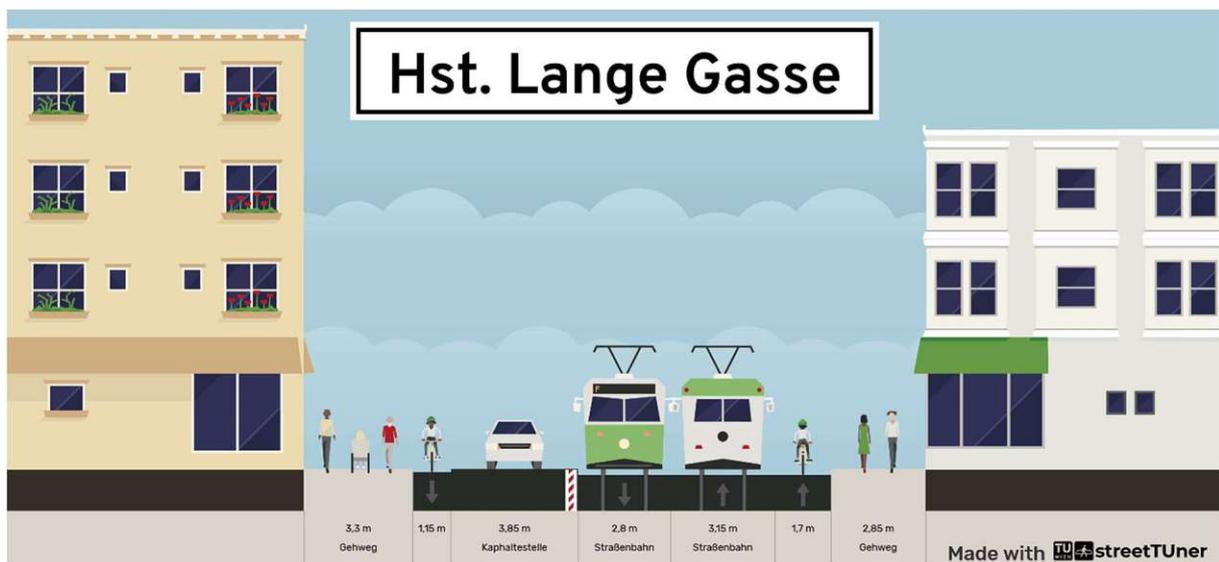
Querschnitt Haltestelle Lange Gasse. Quelle: TU Wien – StreetTuner (streettuner.fvv.tuwien.ac.at)
